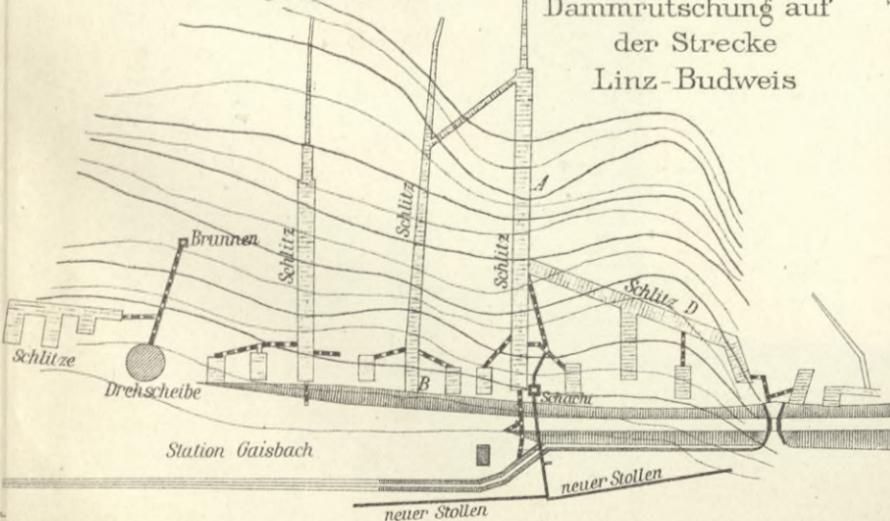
Dammrutschung auf der Strecke Linz - Budweis
